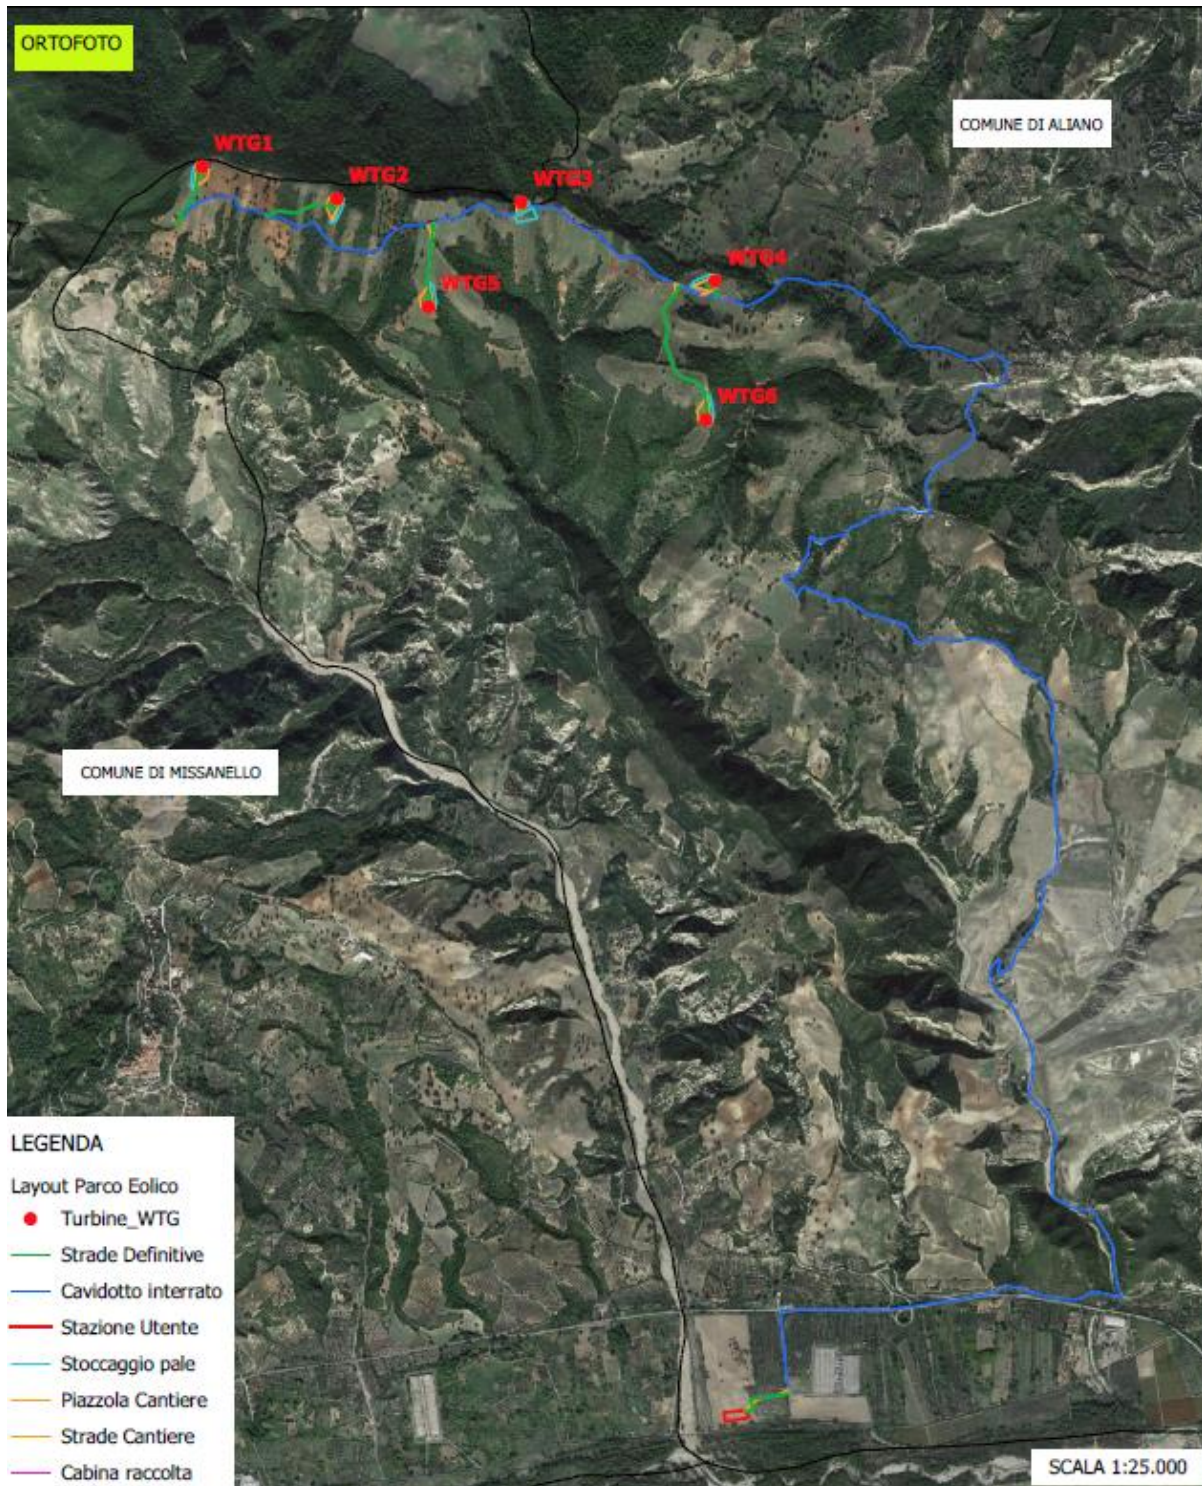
Ortofoto con indicazione delle posizioni delle WTG e cavidotto
